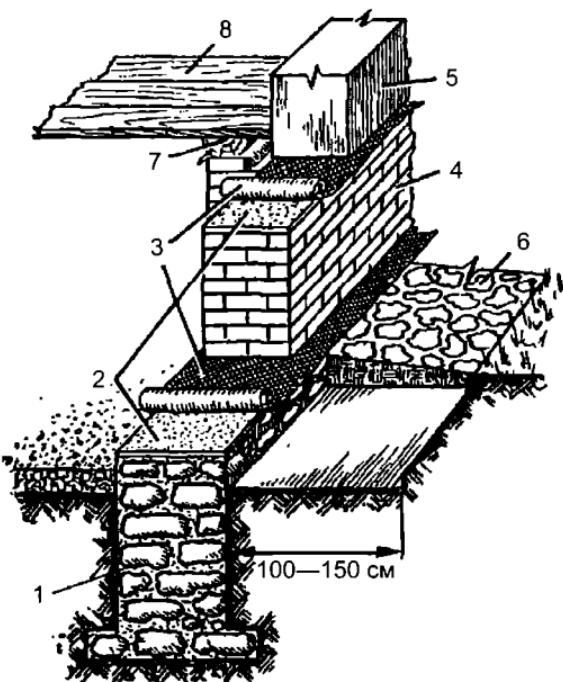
Фрагмент стены с бутобетонным ленточным фундаментом:
